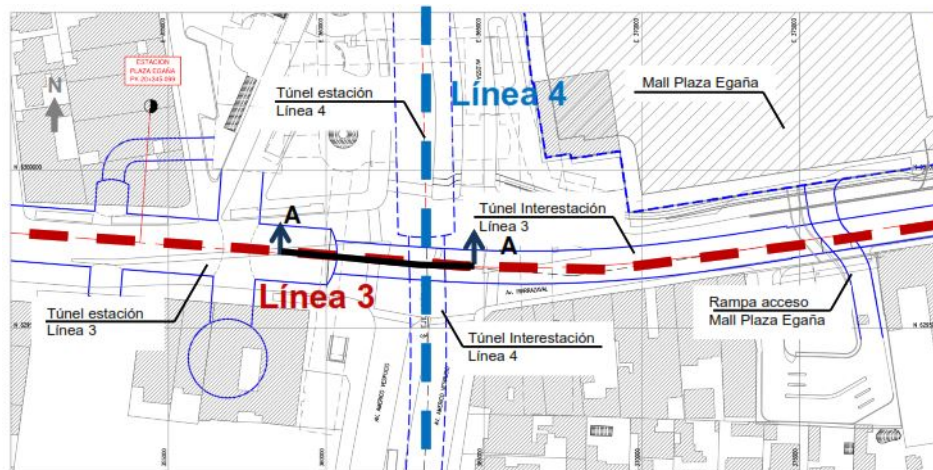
Vista en planta cruce estación Plaza Egaña
